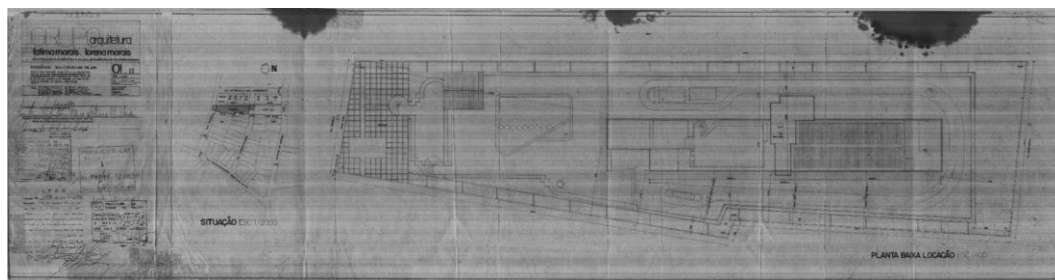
Planta de locação do edifício Maison Van Gogh, 1993, Grupo Arquitetura.
